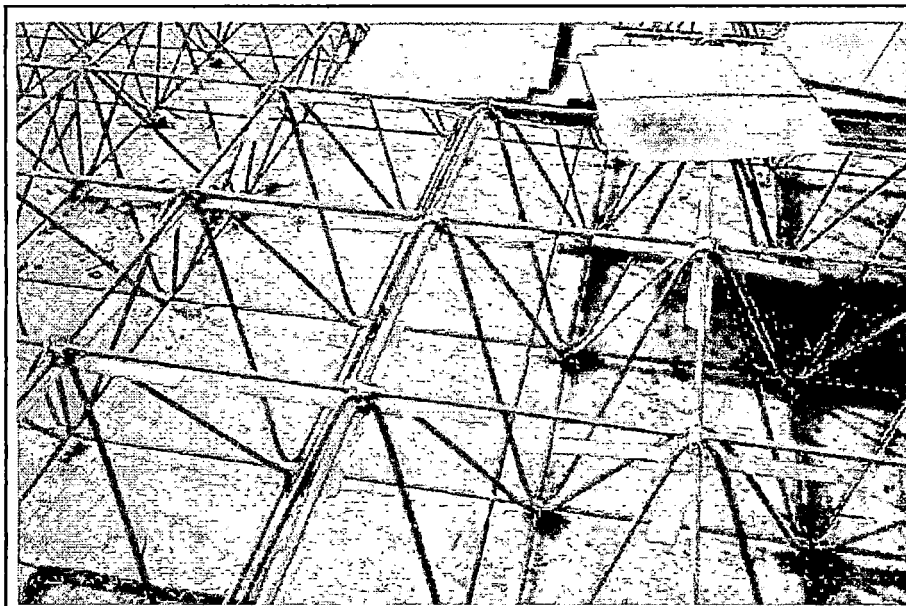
Vista opuesta de la fotografía N°5-13
